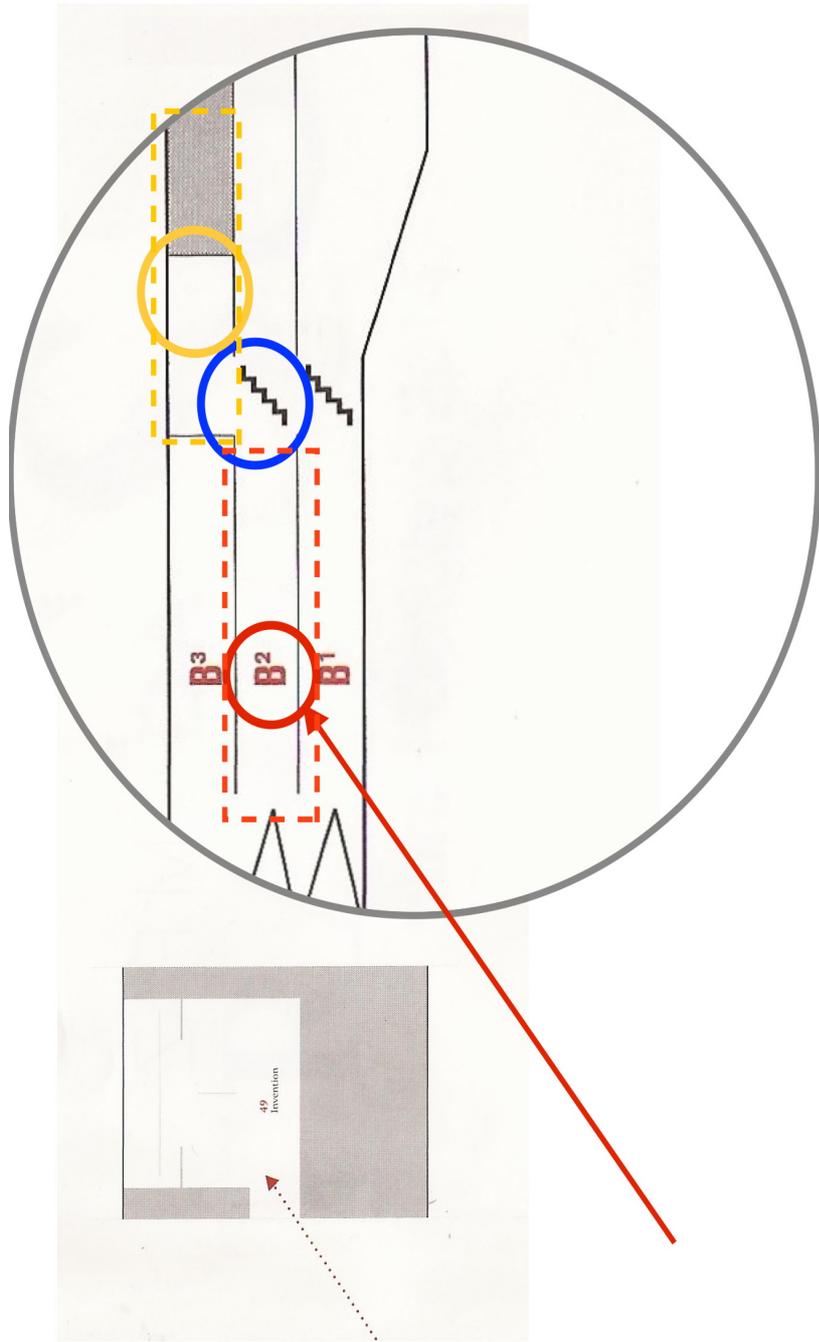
Detalhamento da obra na planta de corte: círculo e retângulo vermelho: salão B2, 2º andar; círculo azul: vão, *hall* e escadarias do acesso I; círculo amarelo: *hall*, após as escadas, no segundo plano; retângulo amarelo: segundo plano da obra, sala *Invention
